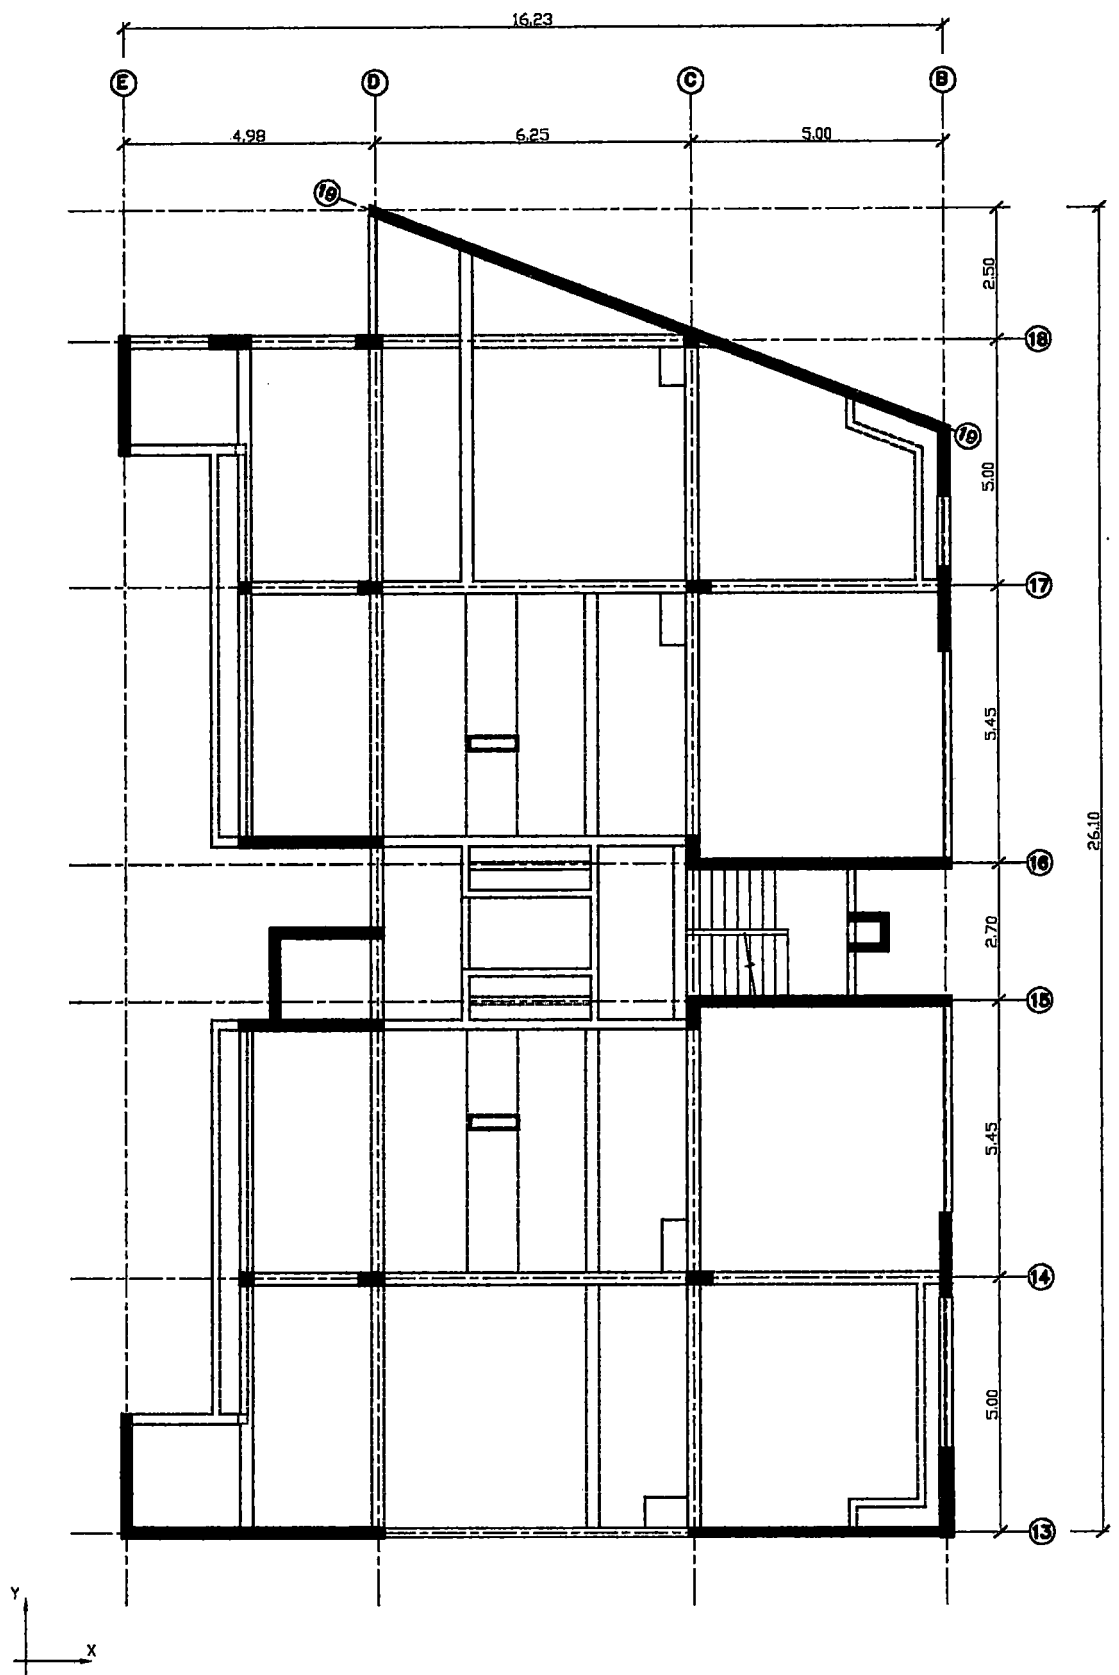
MÓDULO III - PLANTA TÍPICA 1
